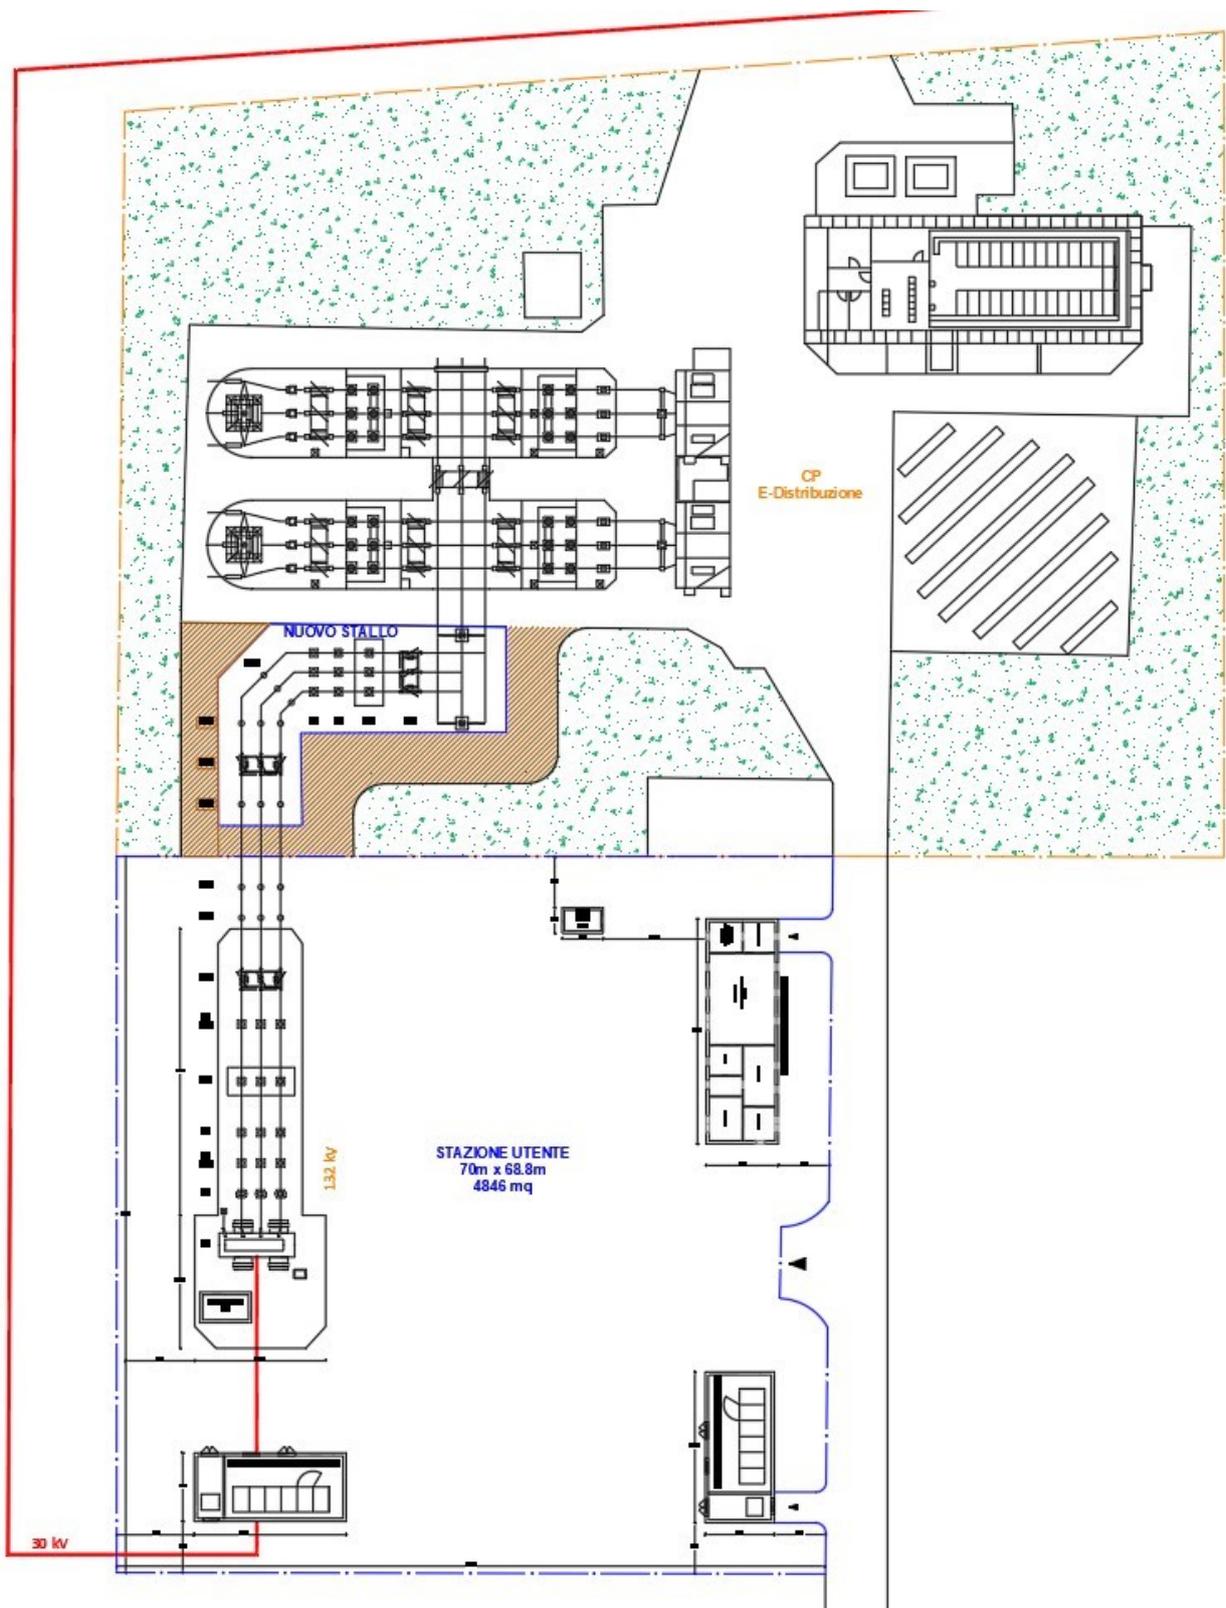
Planimetria generale Stazione Utente e Impianto di Rete (vedi Tav 4.4 allegati)
